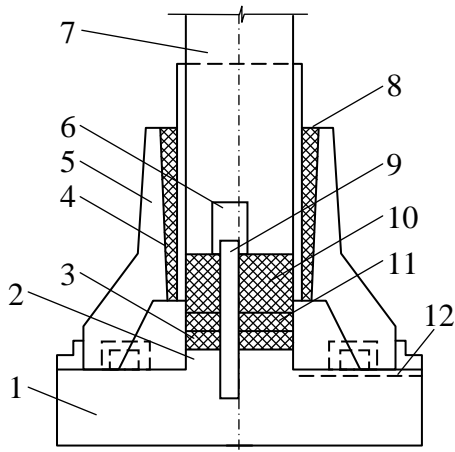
Окремий фундамент для вирівнювання колон за методом опускання: 1 – фундаментна плита; 2 – опорний виступ; 3 – термоелемент; 4 – шар поліетилену; 5 – підколонник; 6 – трубка; 7 – колона; 8 – бетон; 9 – напрямний стрижень; 10 – термовкладиш; 11 – азбест; 12 – борозна для кабеля
